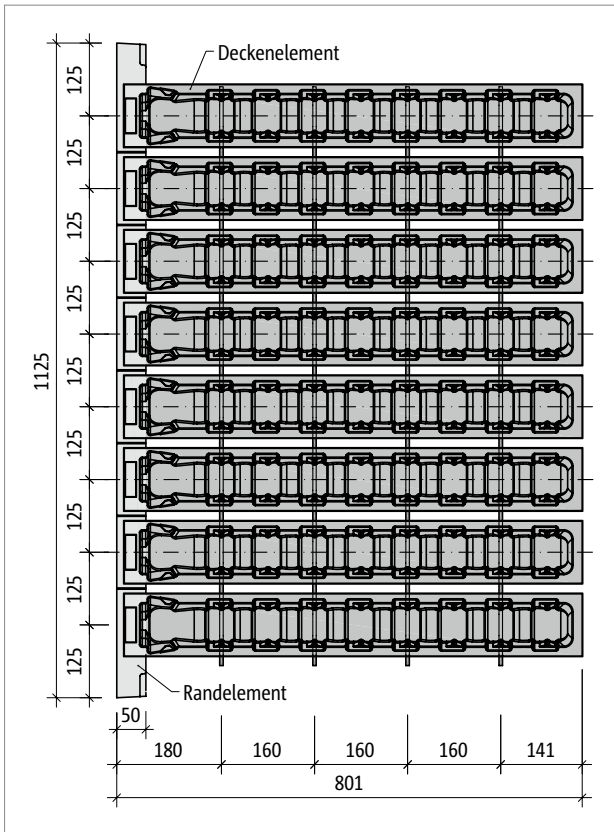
Schöck IDock®: Produktgrundriss IDock1
